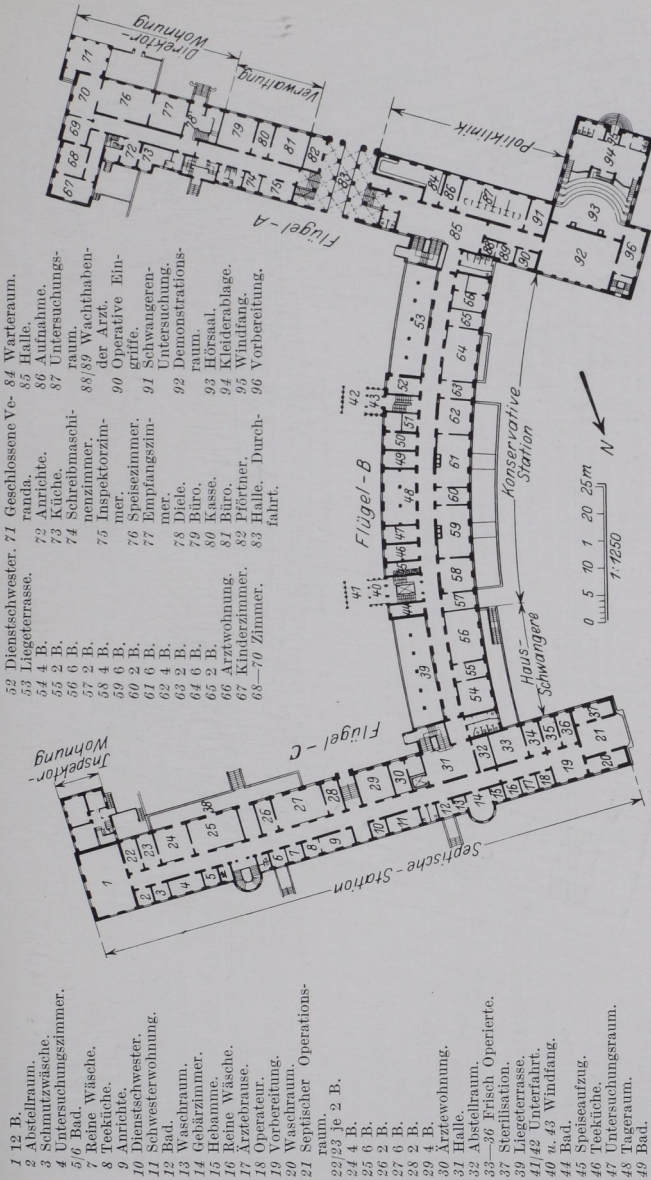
Grundriß vom Erdgeschoß des Hauptgebäudes der Universitätsfrauenklinik Leipzig.
